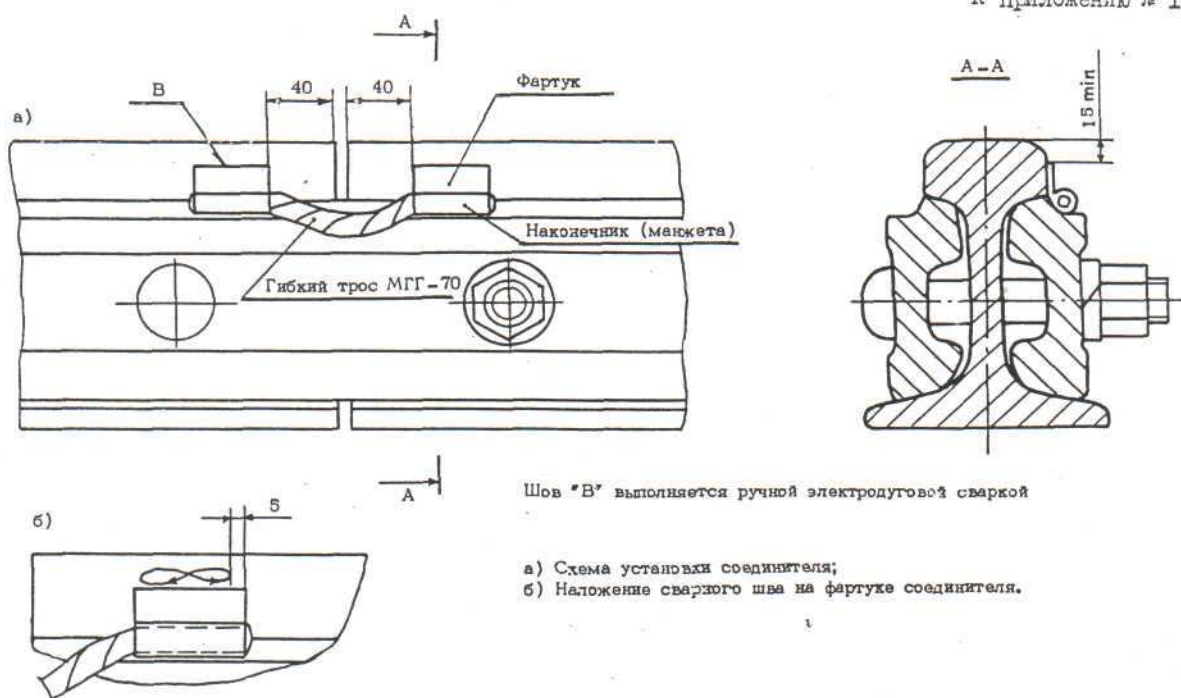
Установка и приварка соединителя фартучного типа РССФ-01
